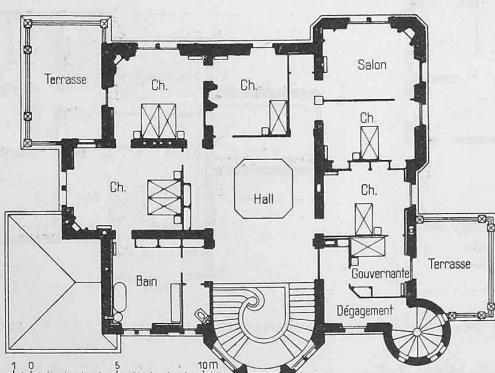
Plan de l'étage supérieur de la villa Fallot. — Echelle 1 : 400.
